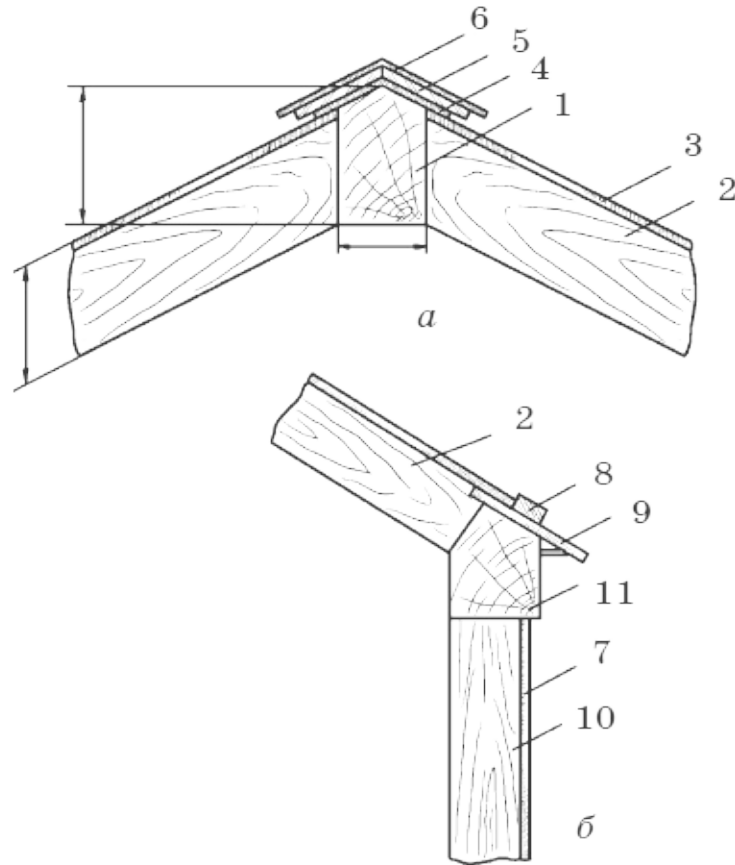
Крепление стропил и шпроса: а — крепление стропил с верхним коньковым брусом; б — крепление шпроса с обвязочным брусом: 1 — стекло; 8 — опорная рейка для стекла; 9 — слив из кровельного железа; 10 — стойка; 11 — обвязочный брус
